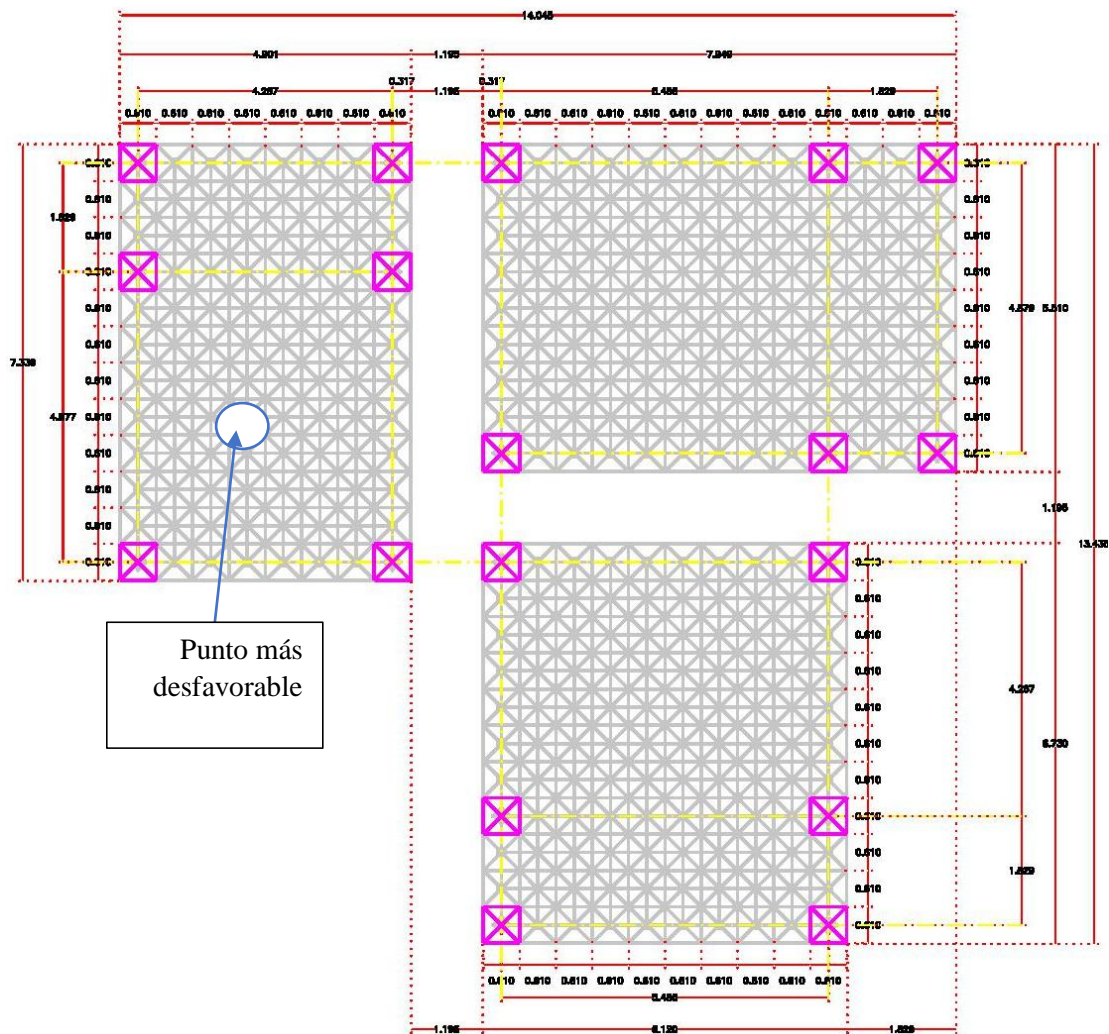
Longitud de diagonales para el cálculo de las deflexiones
